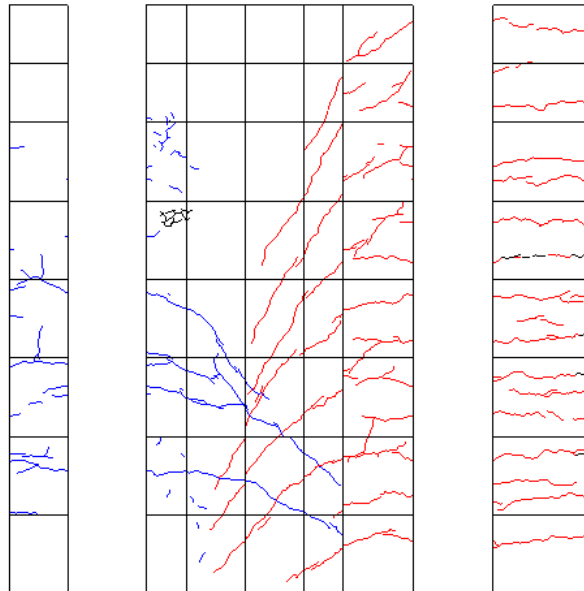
R=-1/133②ひび割れ図
